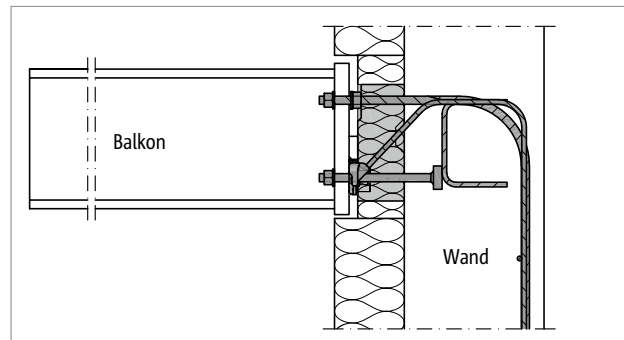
Schöck Isokorb® T Typ SKP-WU-M1: Sonderkonstruktion für Wandanschluss auf Basis der Haupttragstufe M1 für Wandstärken ab 200 mm
